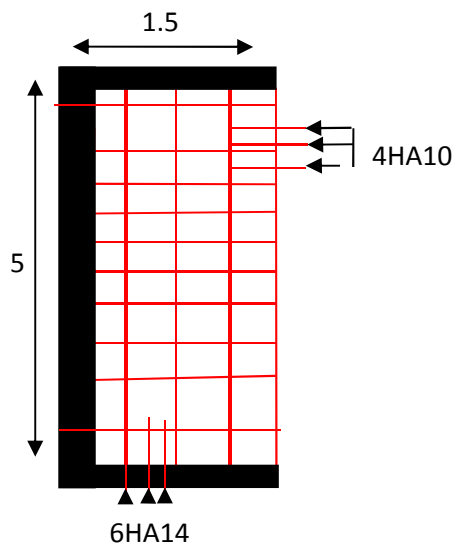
Schéma ferrailage de dalle sur 3 appuis (plancher)
